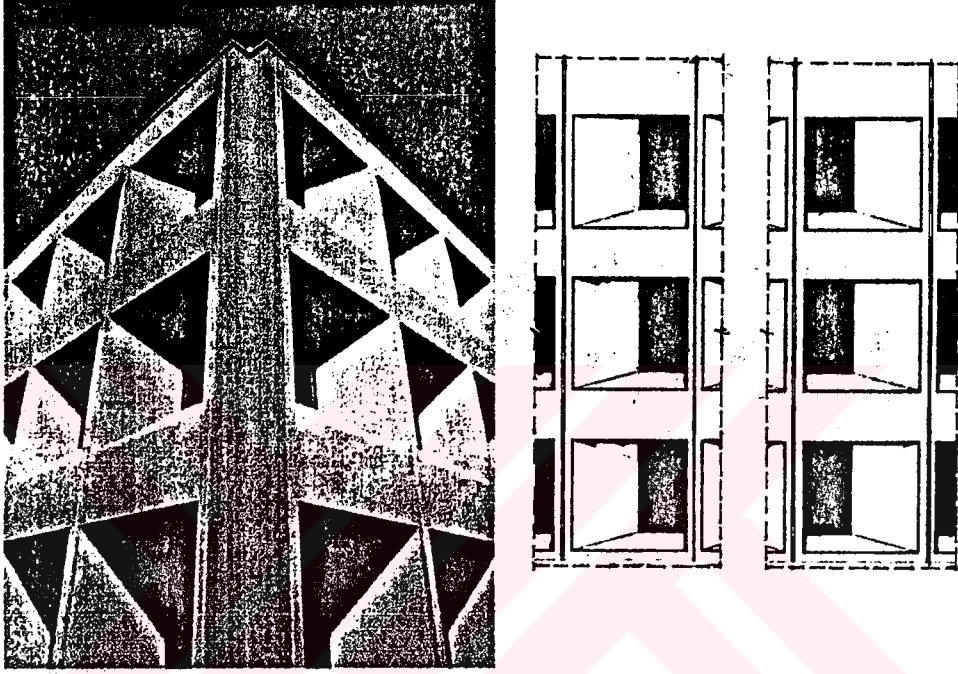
Beton Esaslı Cephe Panellerinde Yatay Gölgeleme Sistemi ile Güneş Korunumunun Sağlanması
